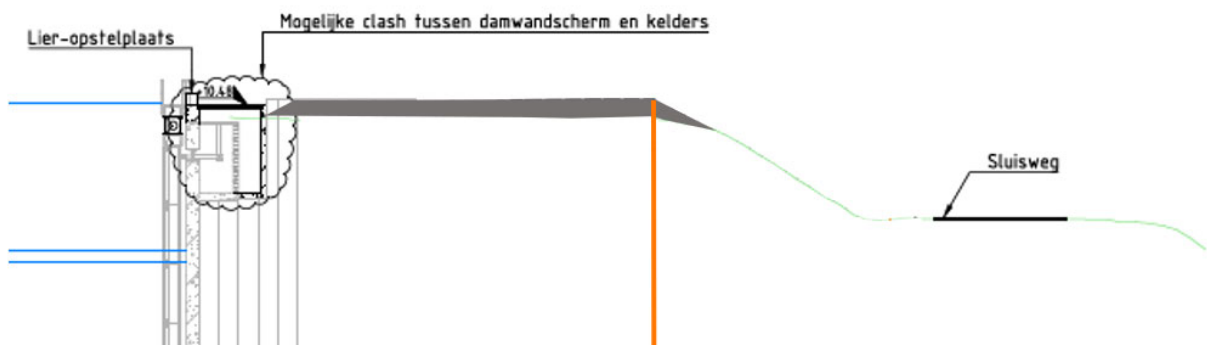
Detailuitwerking zuidzijde sluis Macharen
